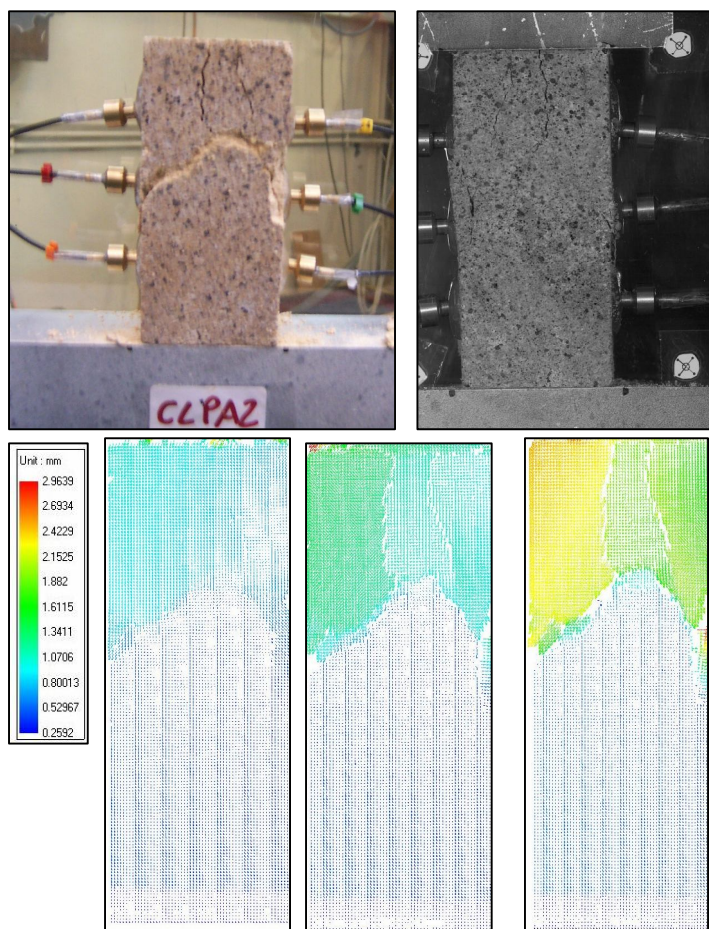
CLPA2 Foto e vettori spostamento ricavati con SEPT-D in tre istanti successivi.
